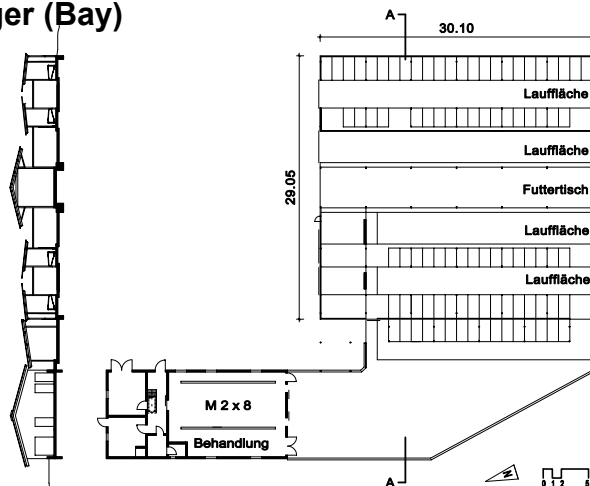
Ansicht, Grundriss – Schnitt
